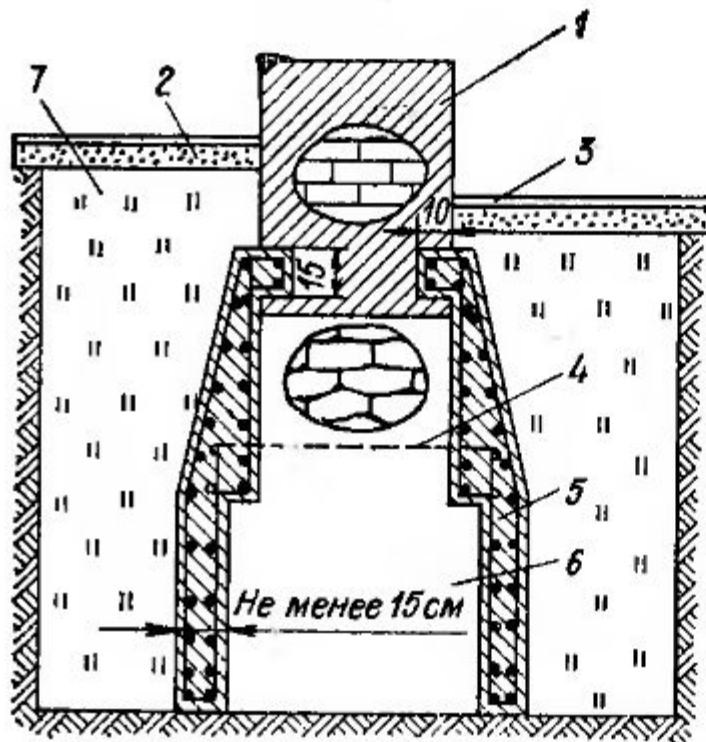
Усиление наружных фундаментов железобетонными обоймами
